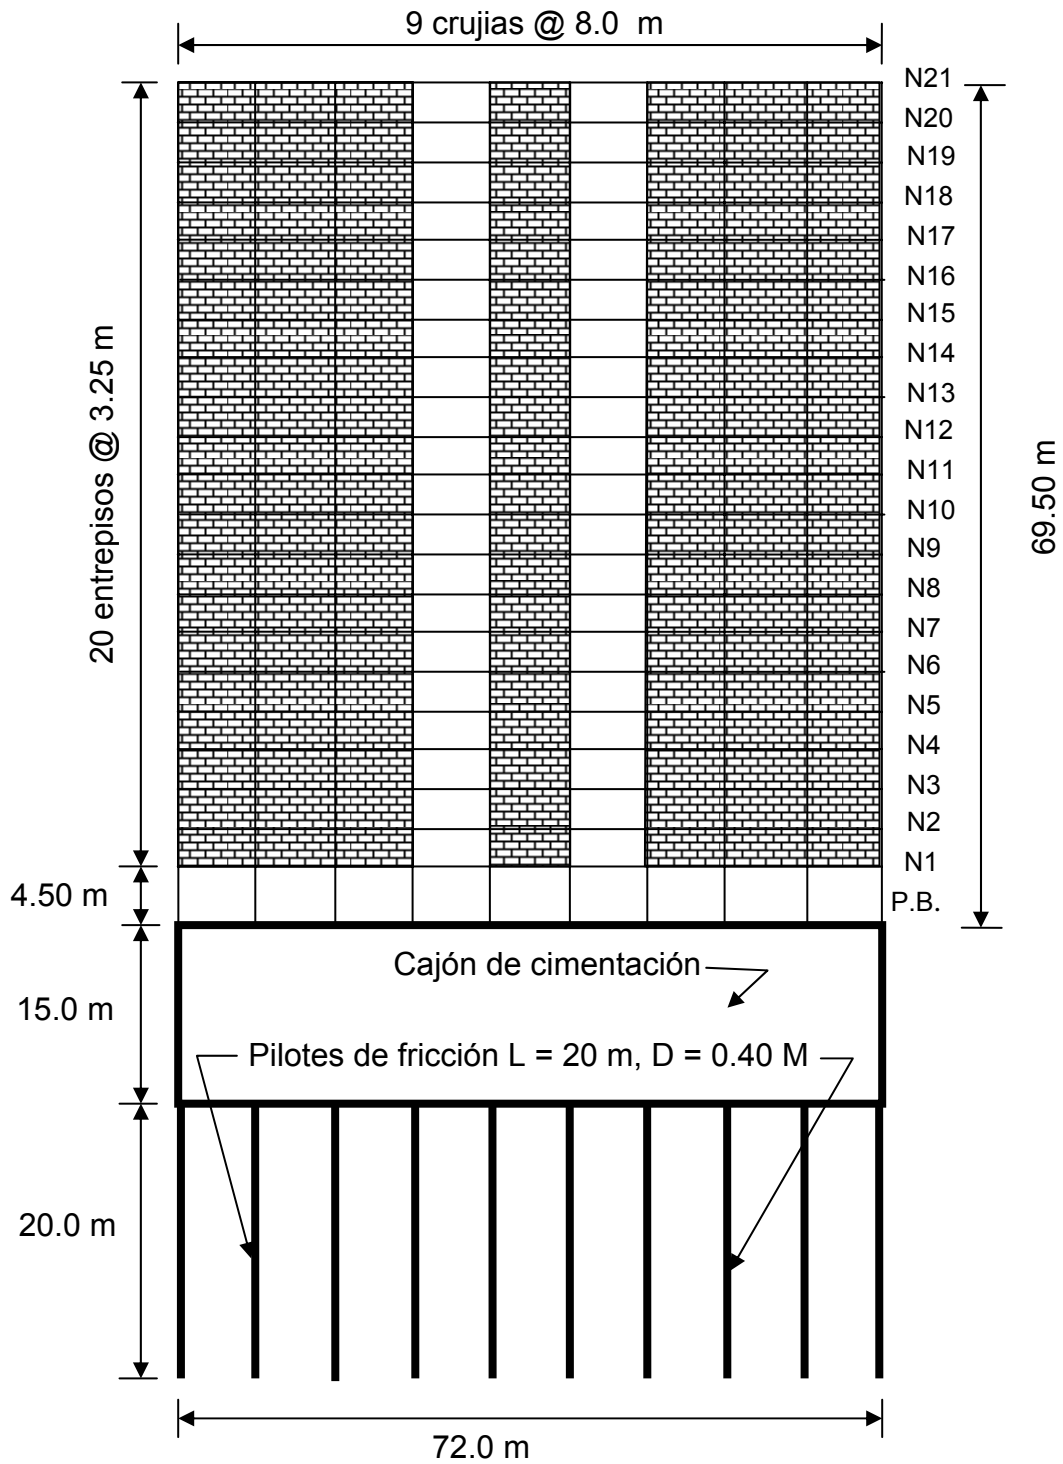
Vista en elevación (corte a-a) de la estructura de 21 niveles
